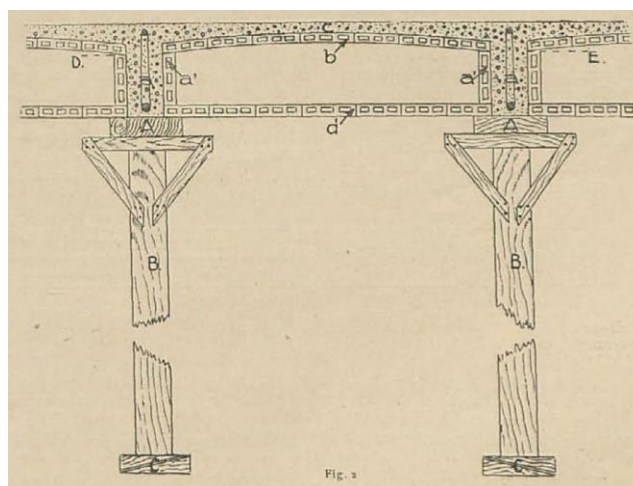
Patente de forjado in situ con cielo raso plano (47)
